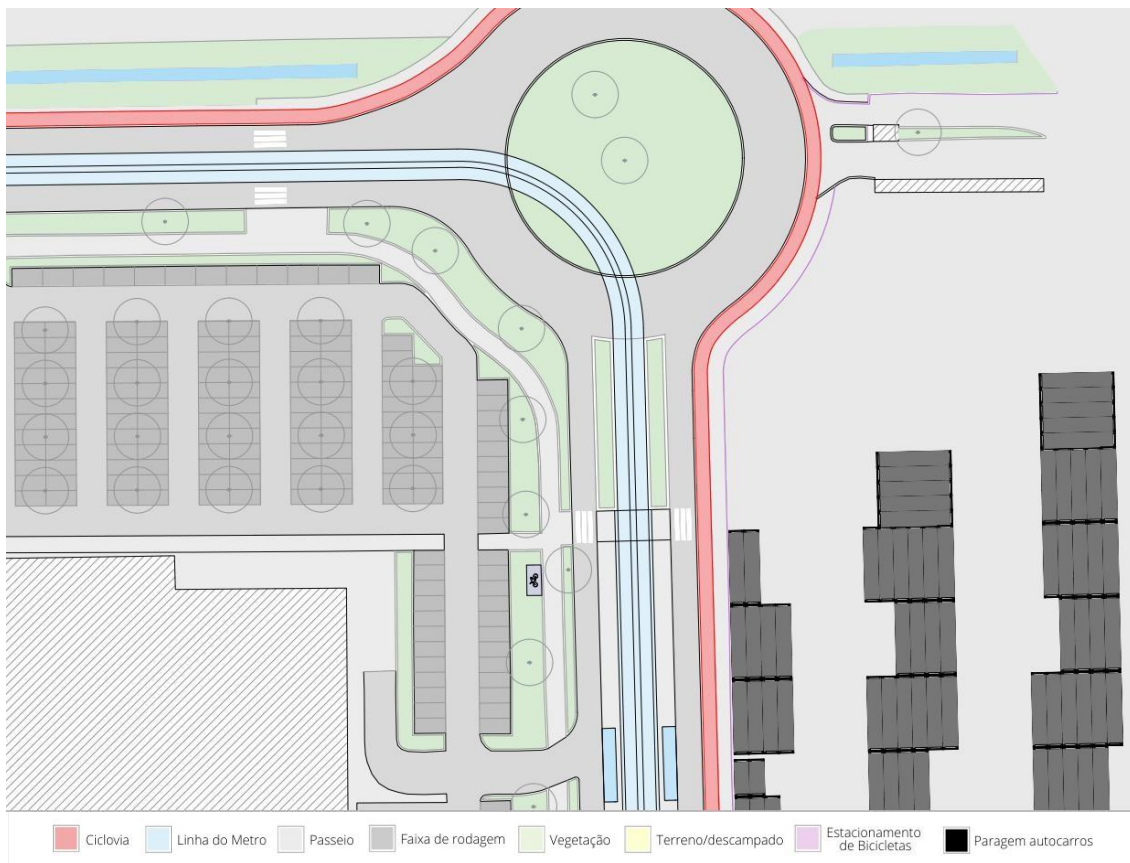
Planta 08 – Avenida Arquitecto Fernando Távora
